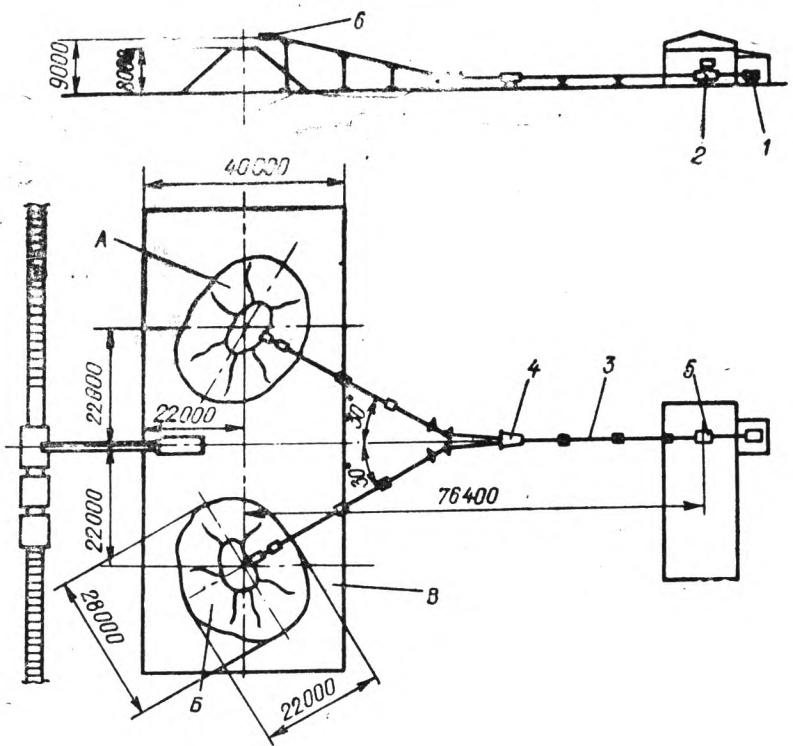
Схема пневмотранспортной установки ТС-66:
